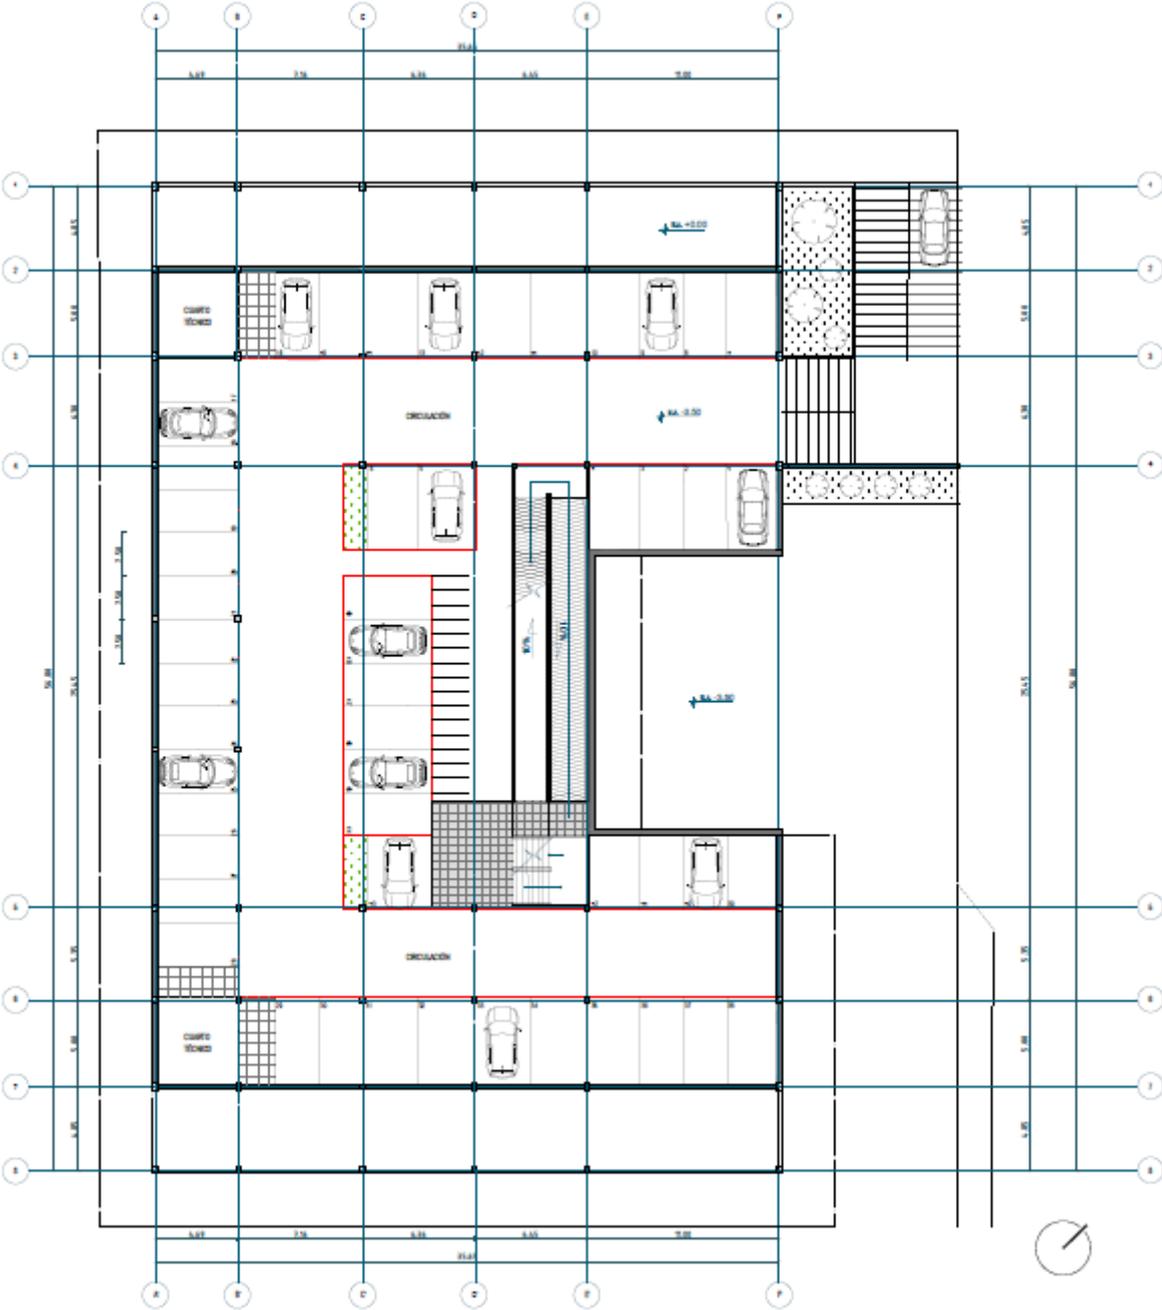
Planta parqueaderos. Fuente: Elaboración propia
